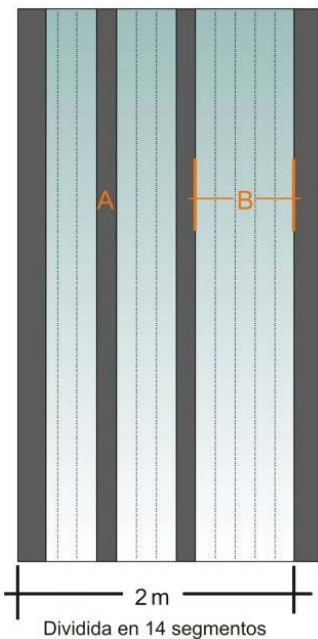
Disposición de elementos verticales entre luces estructurales.
